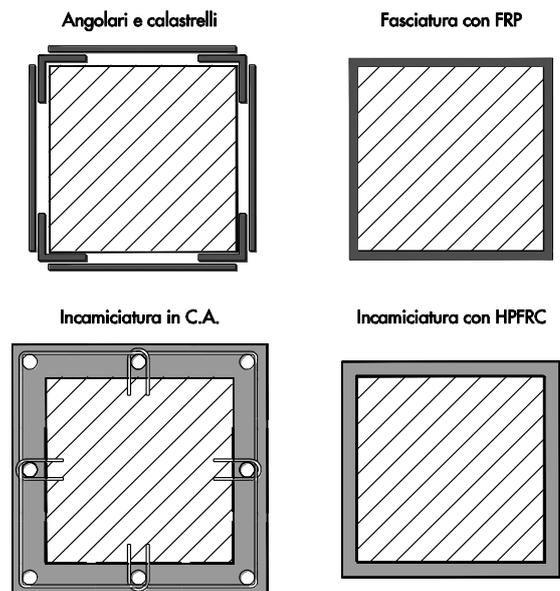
Interventi di confinamento e rinforzo della base del pilastro.
